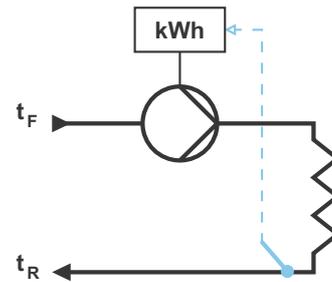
MAGNA3 mit integrierter Wärmemengenerfassung
